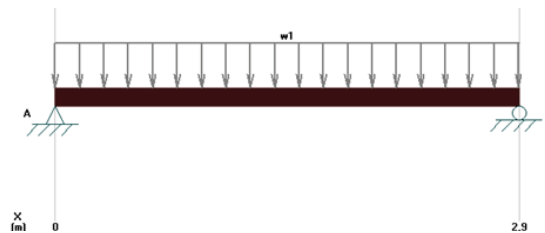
Viga simplemente apoyada (Fuente propia)
